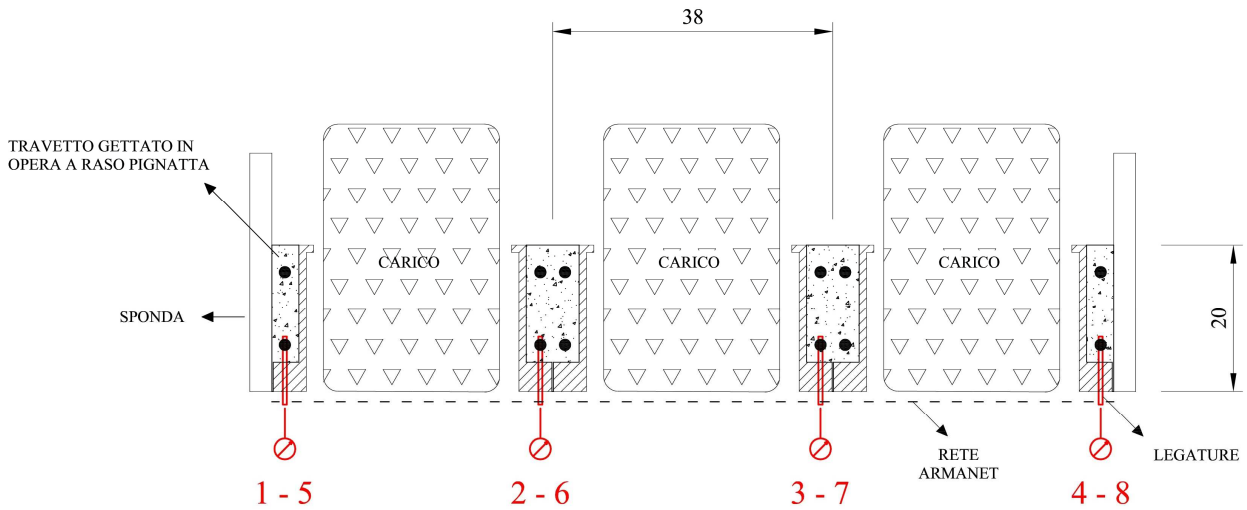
Sezione trasversale del solaio in fase di carico con l’ingombro delle taniche
